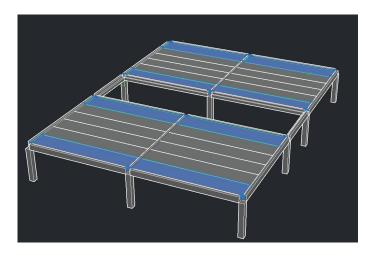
Ubicación de losas prefabricadas sector departamentos. Fuente: Elaboración propia.
